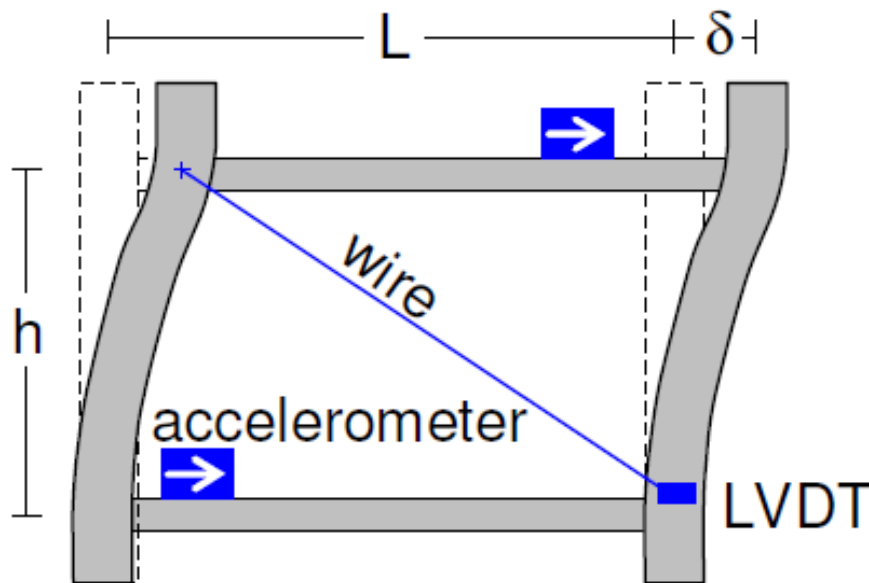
Schema di misura con l'utilizzo di sensori LVDT [103].
